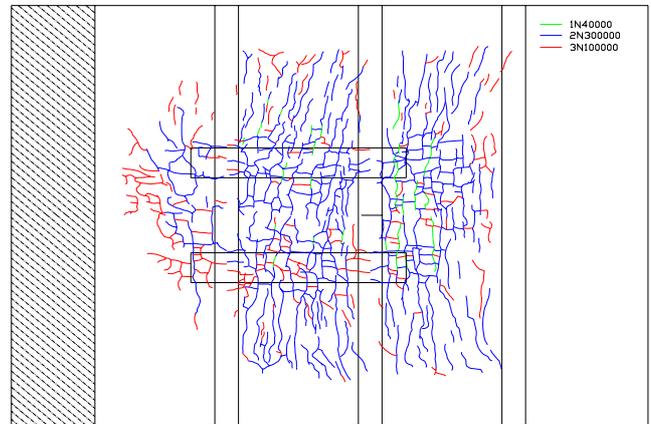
軽量床版下面（繊維無し）のひび割れ状況
